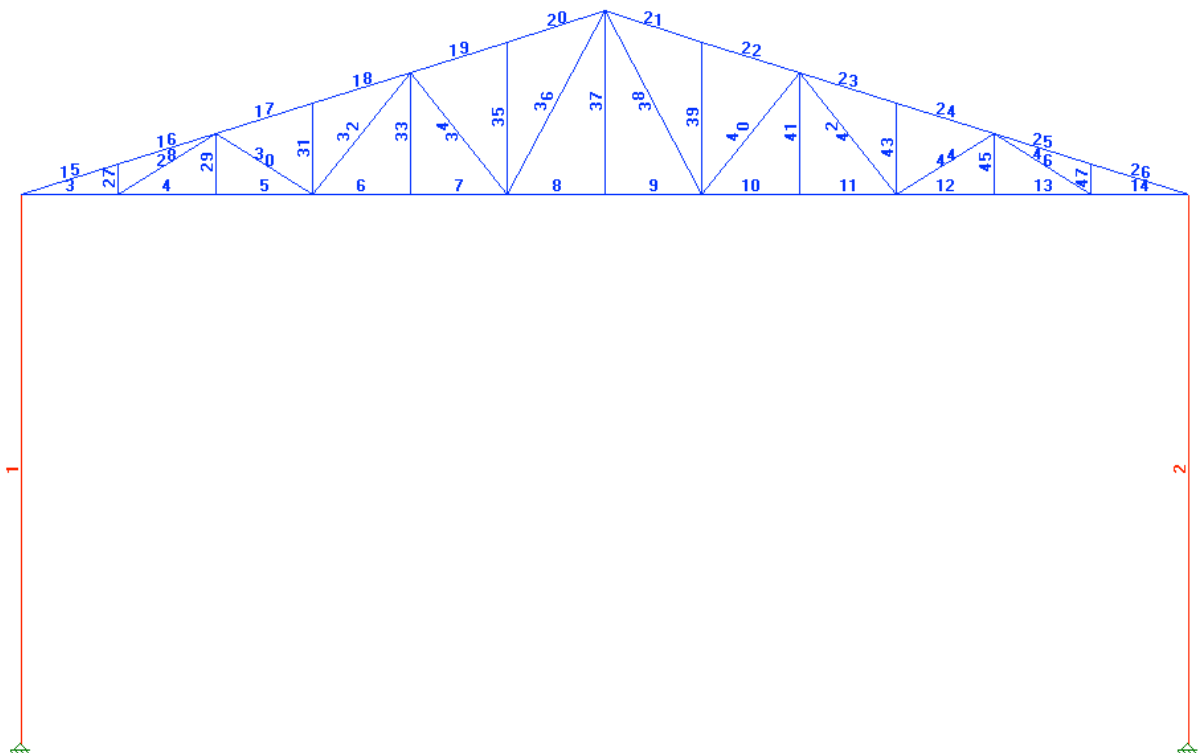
Esquema do pórtico utilizado no dimensionamento, medidas em cm
